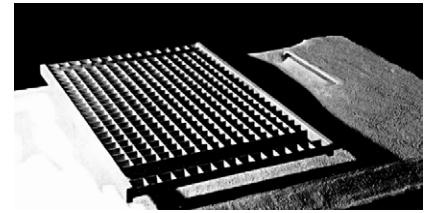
Pabellón de Brasil para la Expo'70. Osaka, Japón. 1969-70
